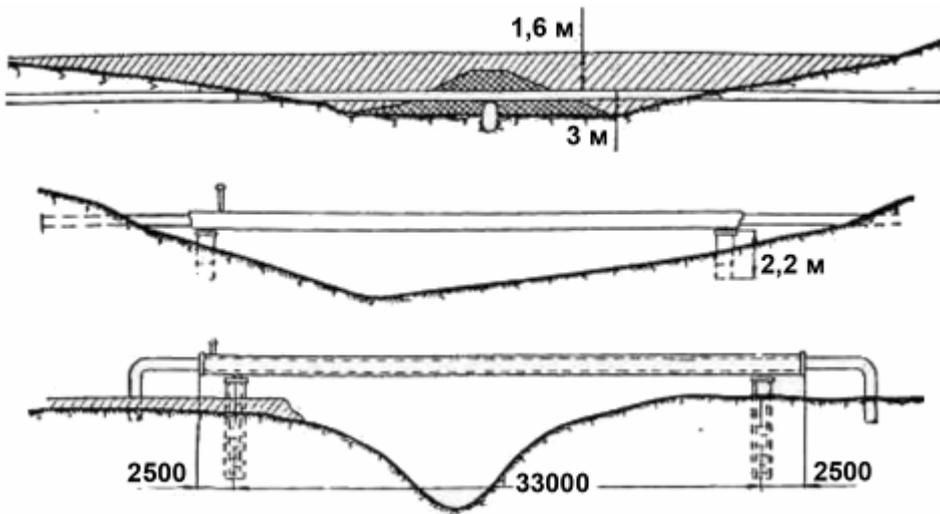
Балочные переходы надземных трубопроводов (<http://www.neftelib.ru/neft-book/022/0/index.shtml>).
